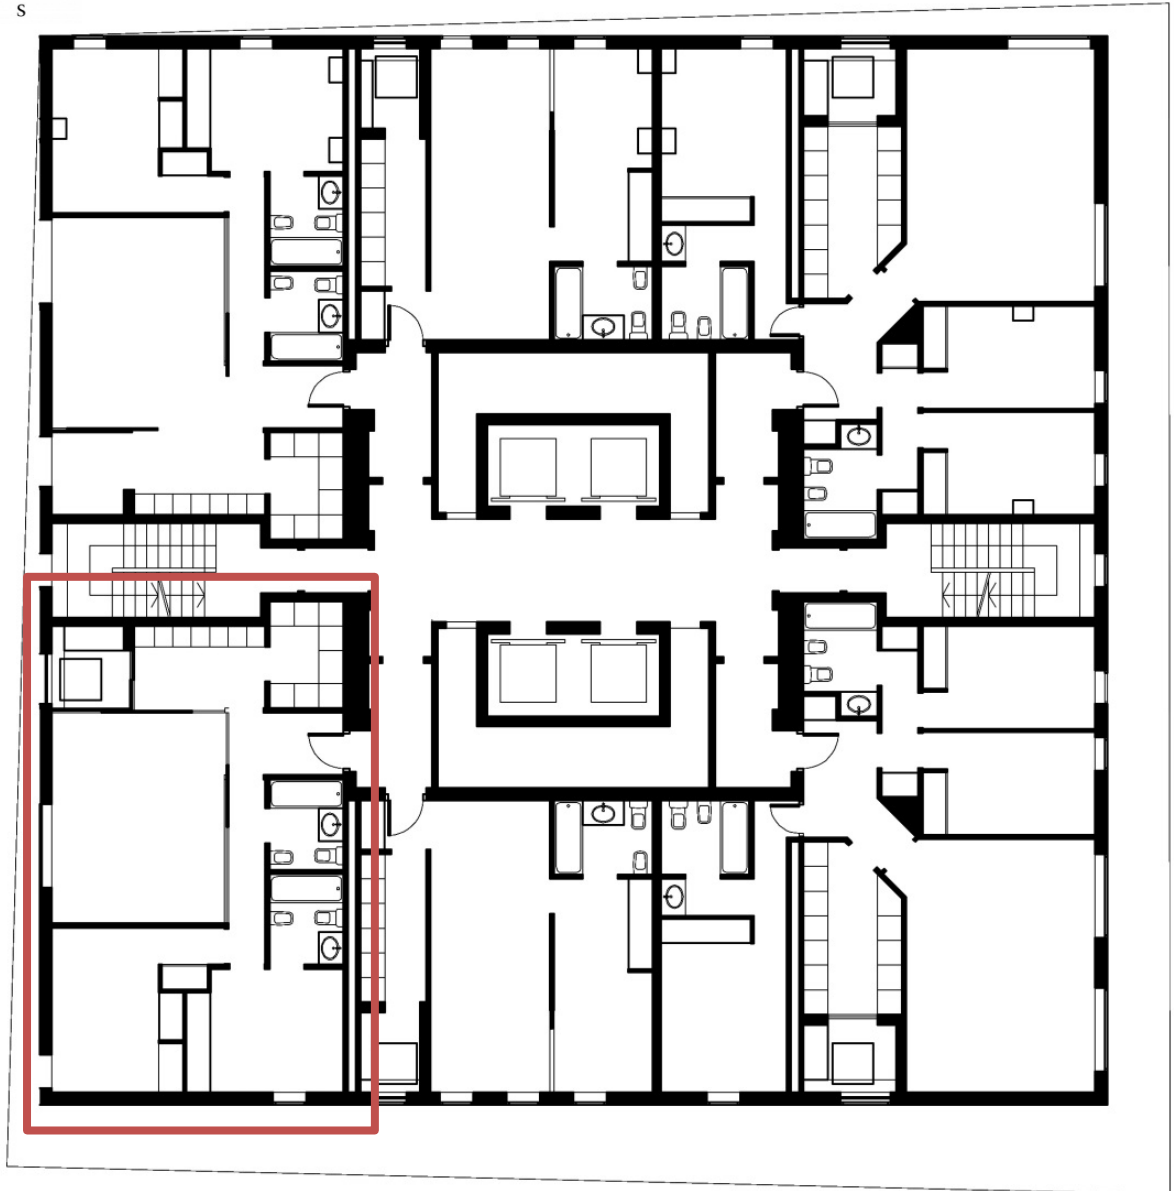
Vista de la quinta planta completa del edificio seleccionado
